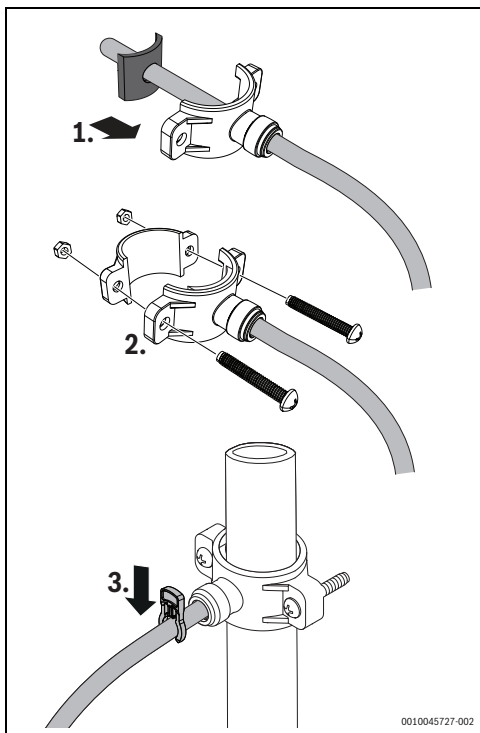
Installation du collier de serrage du tuyau des eaux usées
